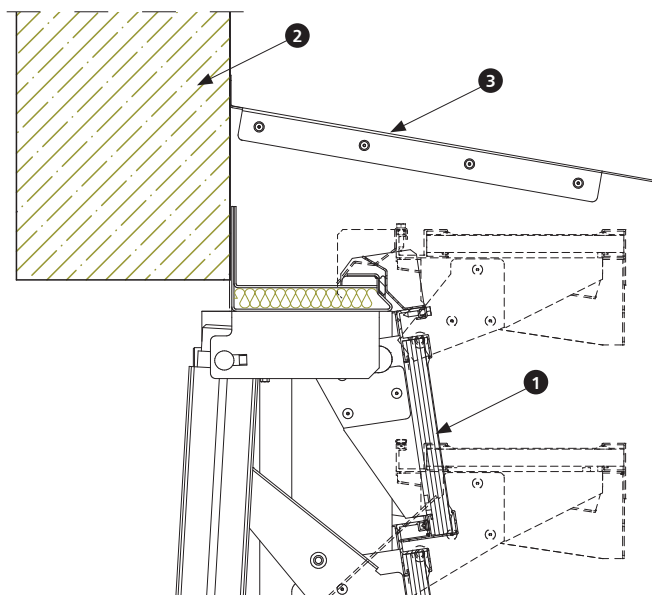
Montaż kłapy żaluzyjowej w ścianie (fasadzie) do konstrukcji wsporczej
